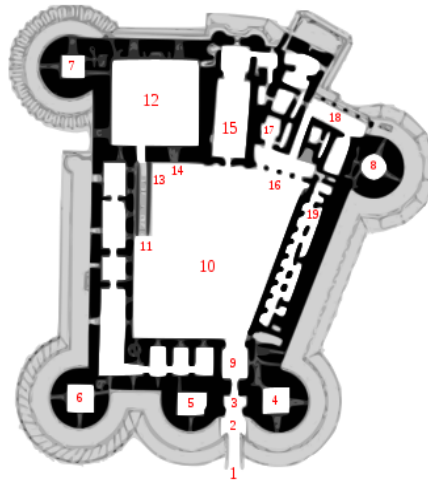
Schema planimetrico tipologico di Castel Nuovo e legenda
